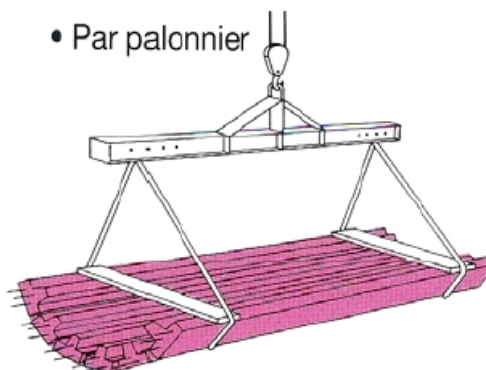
Mise en œuvre des planchers avec poutrelles préfabriquées 3
